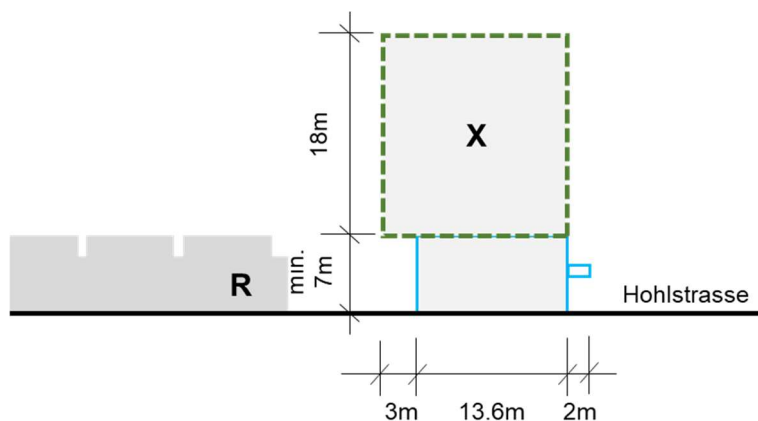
Gebäude X: Gebäudedimensionen (Mantellinie) im Schnitt gemäss Bebauungsregeln Masterplan
